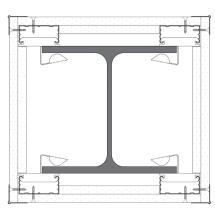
Protection poteau simple peau avec bandes de plâtre
